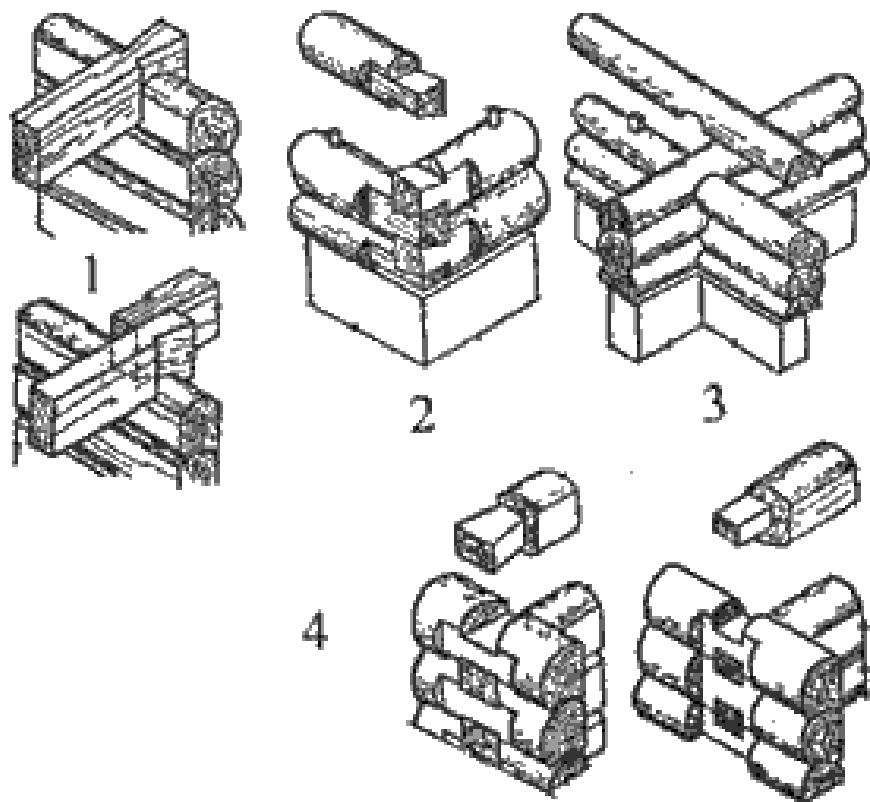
Угловые соединения бревен: 1 — соединение бревна с балкой перекрытия; 2 — в «лапу», 3 — в «чашу»; 4 — соединение внутренней стены с наружной.
